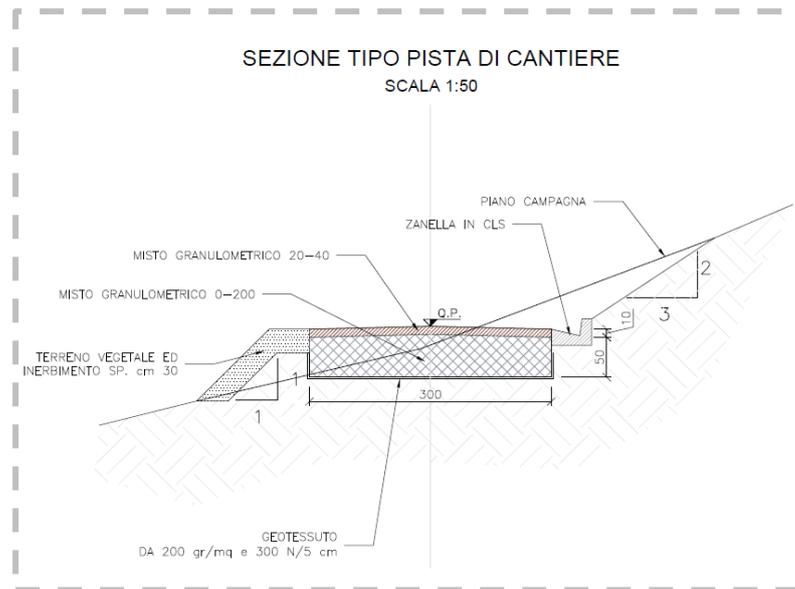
Sezione tipo piste di cantiere nuova realizzazione
